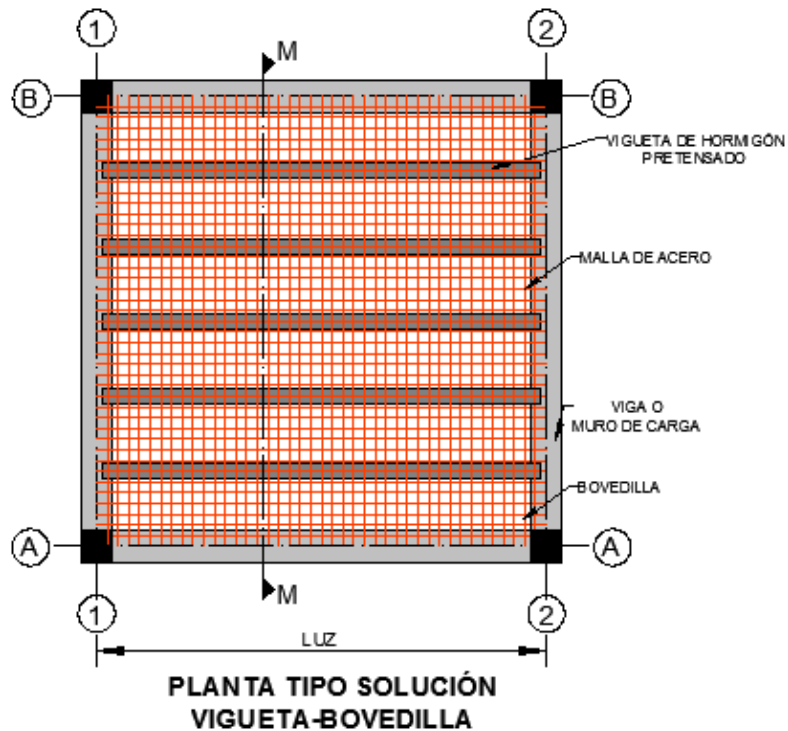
Planta Tipo Solución Vigueta-Bovedilla incluye malla de acero. Diseño: Antonio Marcos Sacoto Toledo. Revisión: Ing. Nelson Navarro Campos. Ph.D.
